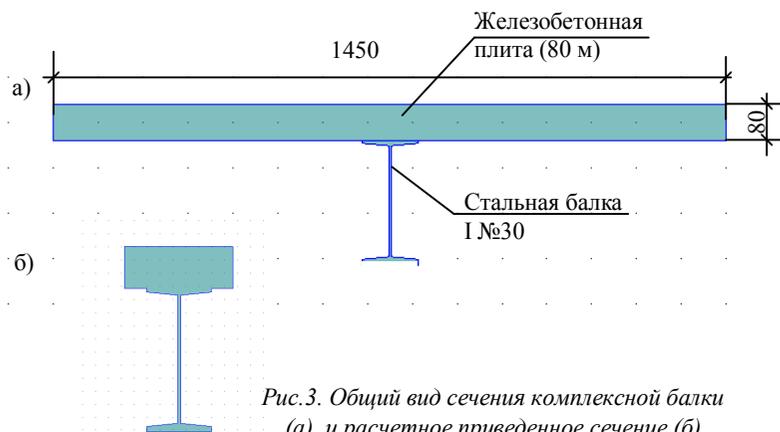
Общий вид сечения комплексной балки (а) и расчетное приведенное сечение (б)
